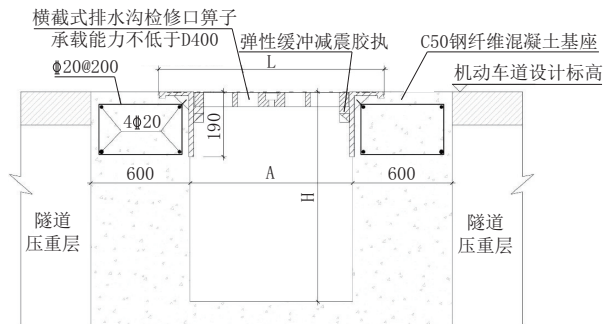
横截式排水沟检修口箅子安装剖面图(单位:mm)
